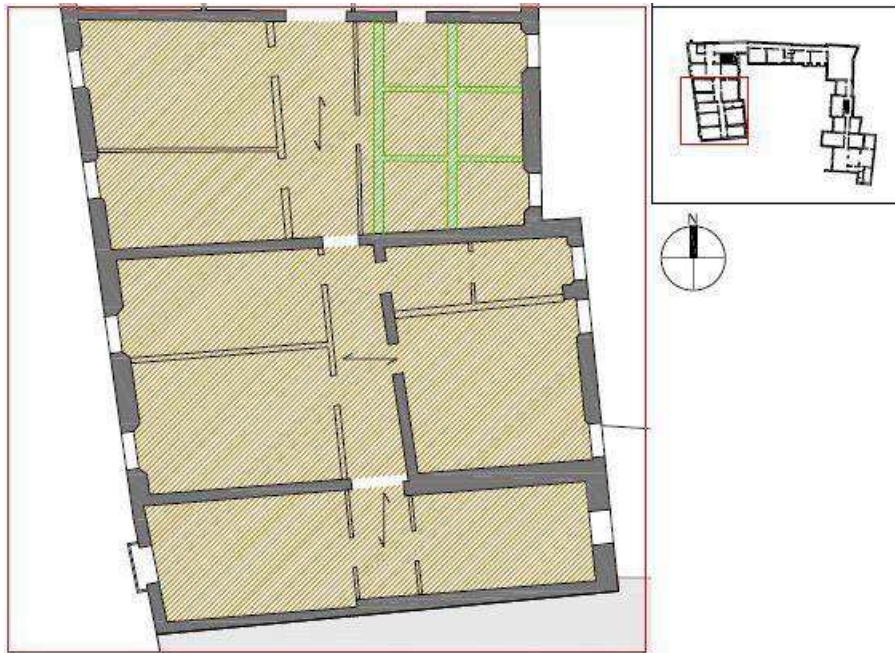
Secondo orizzontamento rilievo strutturale
